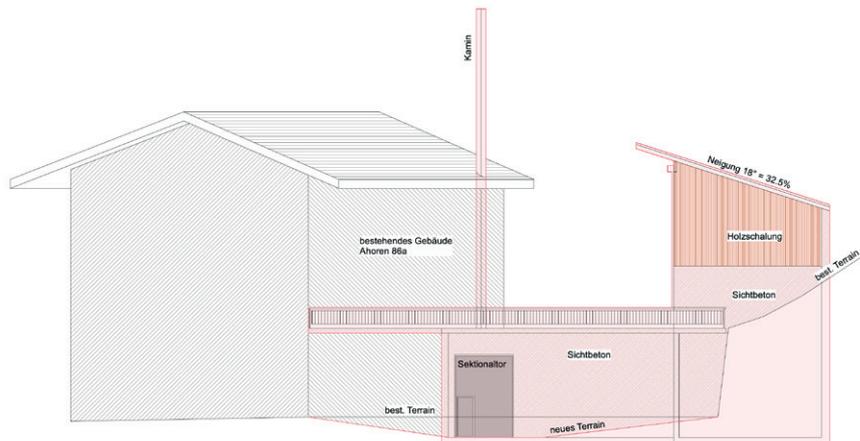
Fassadenansicht Süd; geplante Bauten und Anlagen in rot; Quelle: Allotherm AG
